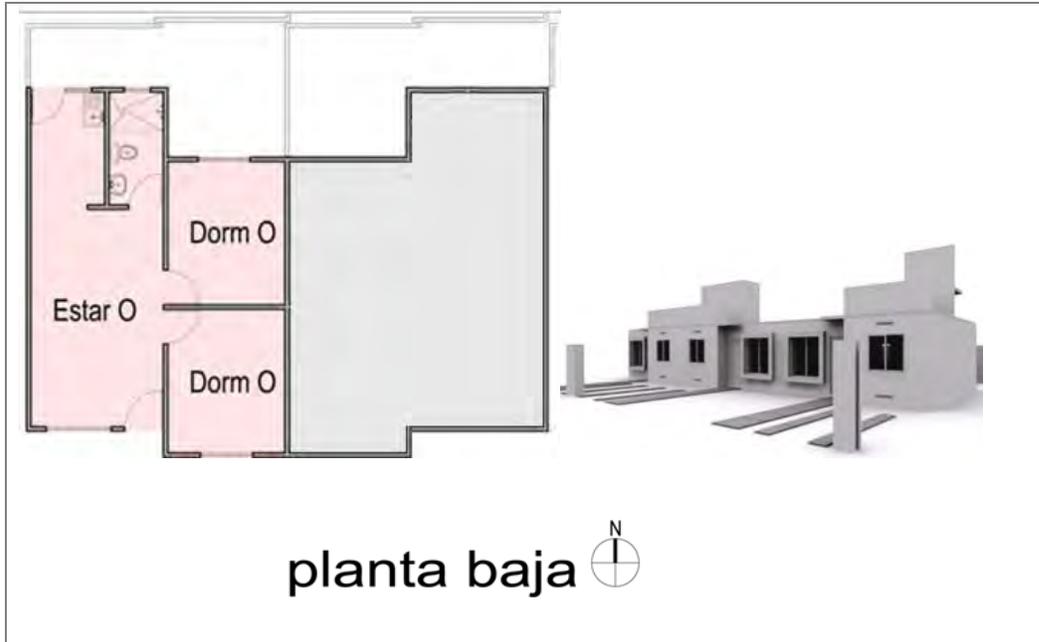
Tipo de construcción Adosada. Planta arquitectónica y maqueta en 3D, sin escala Fuente: [Campos 2011]
